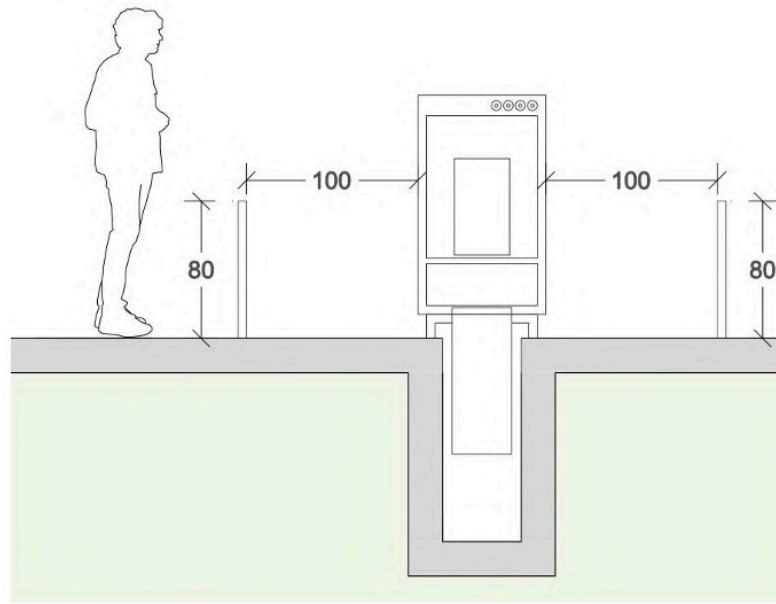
Protección de la maquinaria de corte de piedra con protecciones fijas de perfil de acero colocado en la solera de hormigón existente
